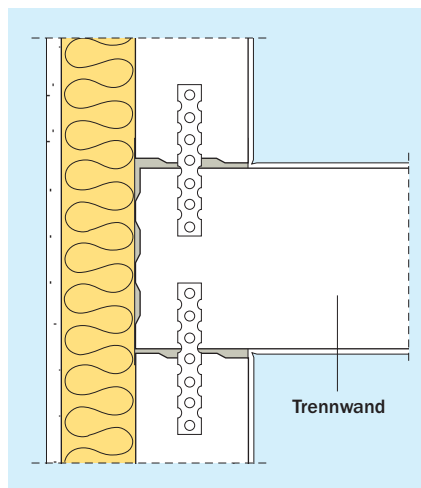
Stumpfstoßtechnik mit durchlaufender Trennwand (Empfehlung bei Schallschutzanforderung)
